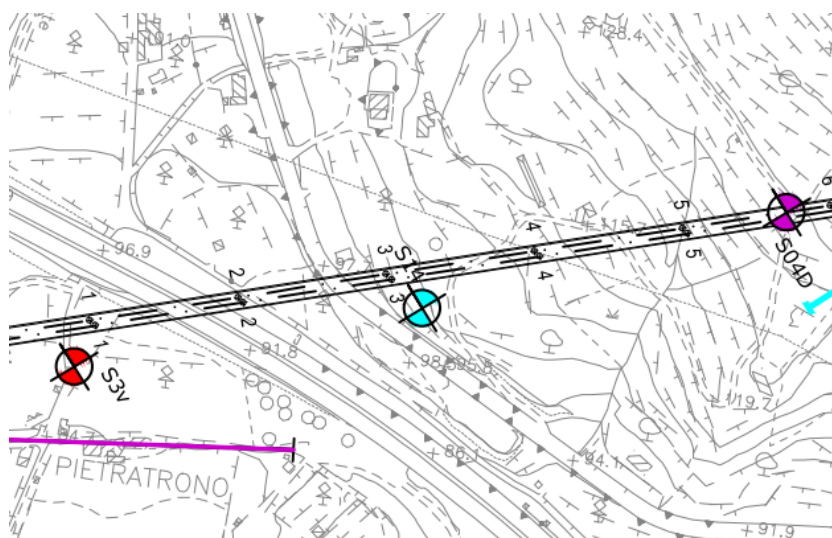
Stralcio planimetrico con ubicazione del sondaggio S14
